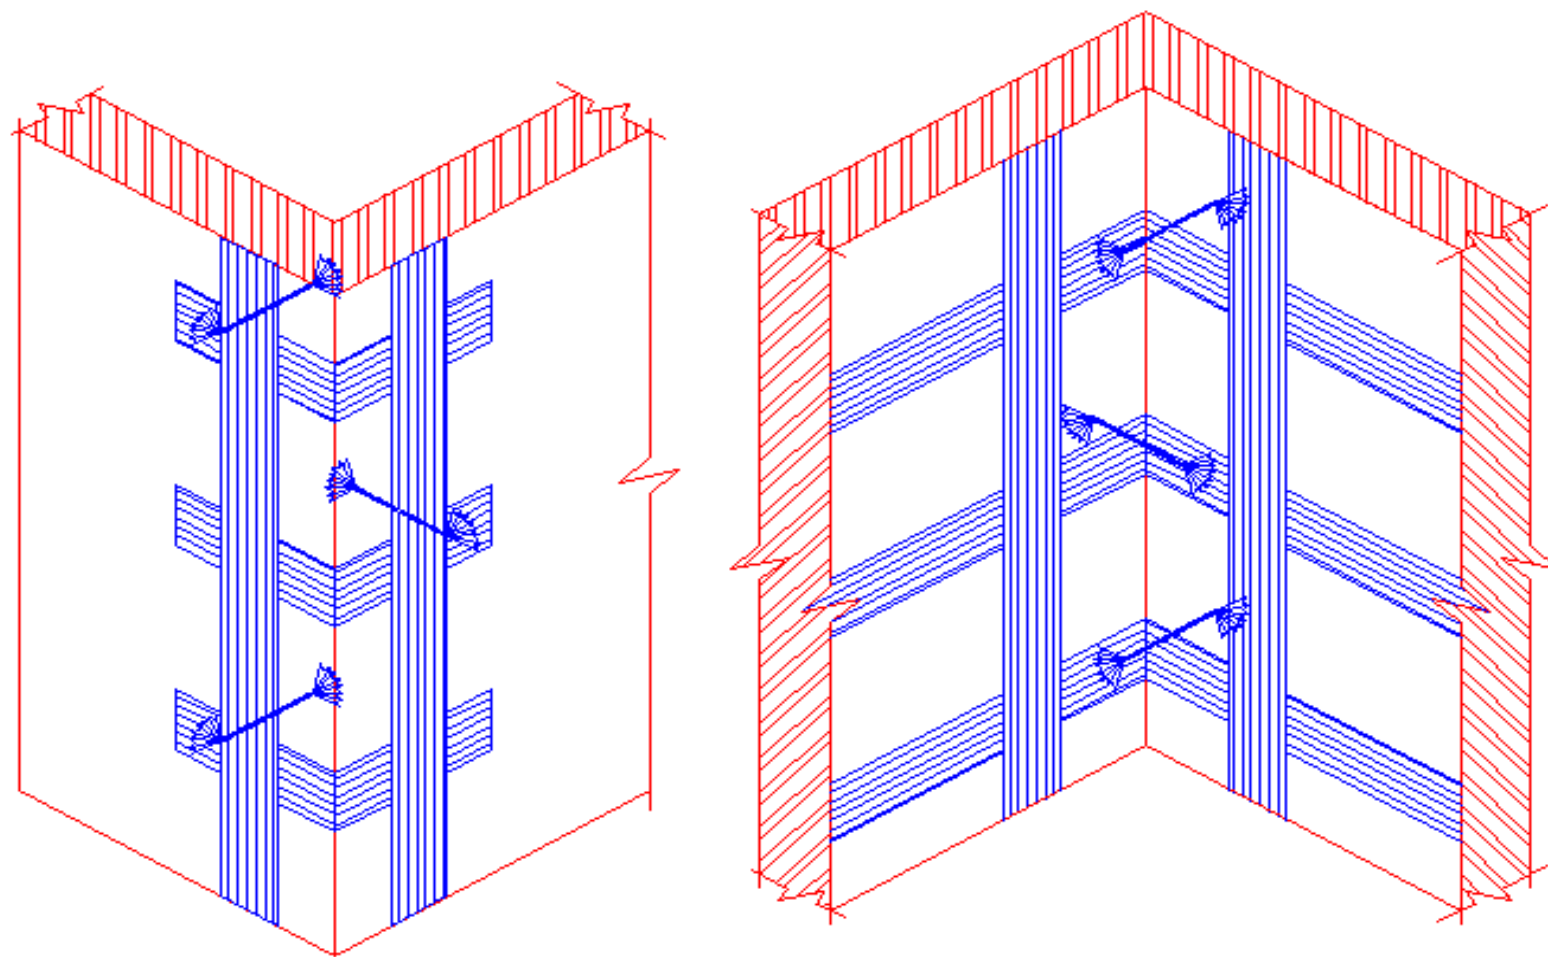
Усиление участка примыкания внутренней стены к наружной стене с помощью холстов из базальтового волокна
